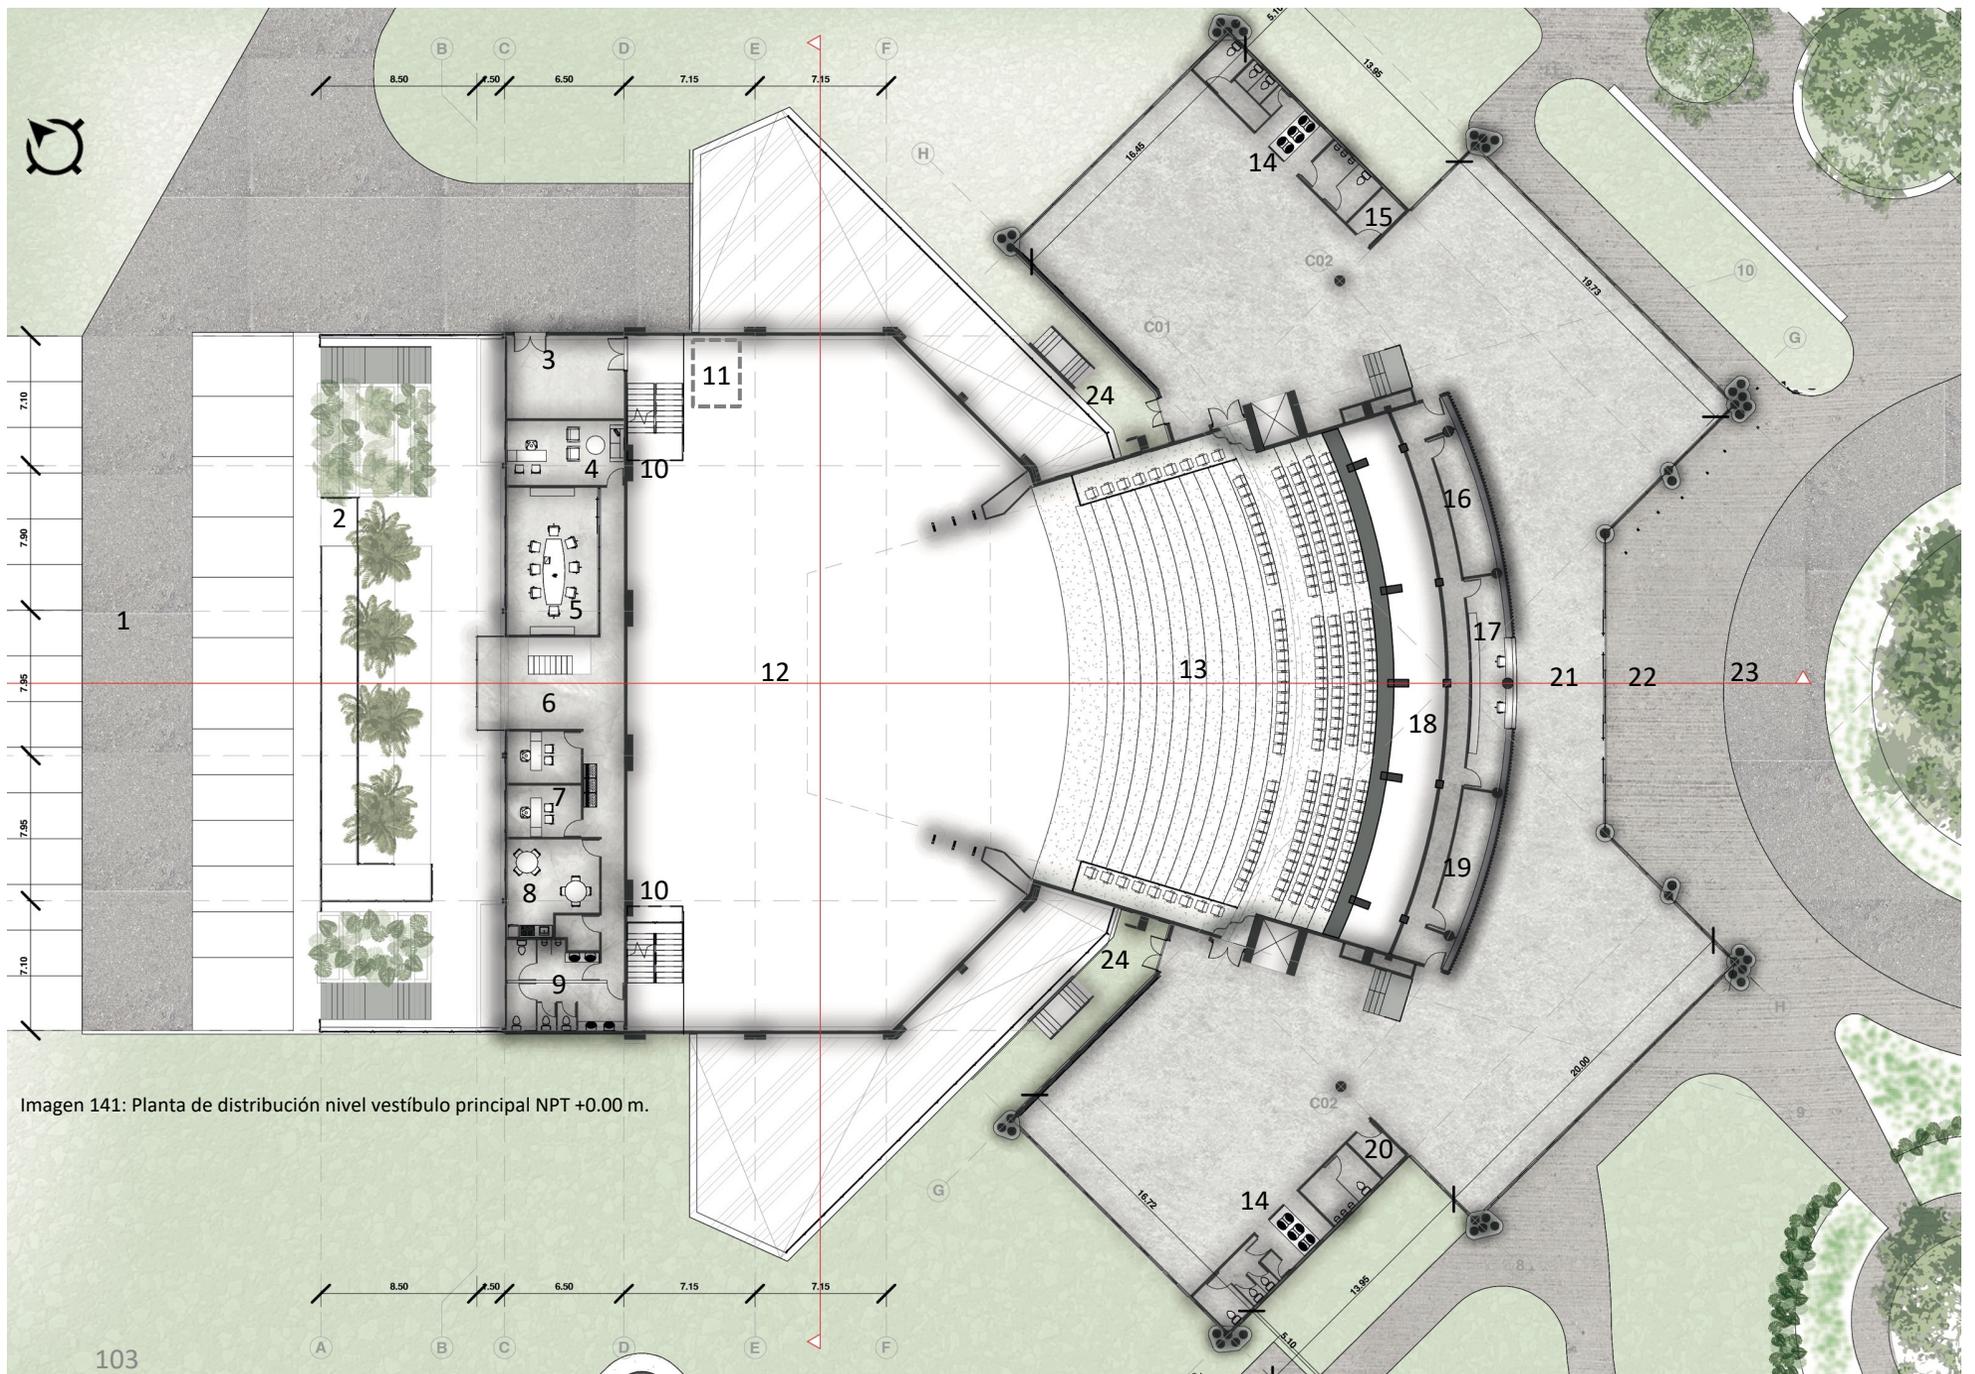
Planta de distribución nivel vestíbulo principal NPT +0.00 m.
